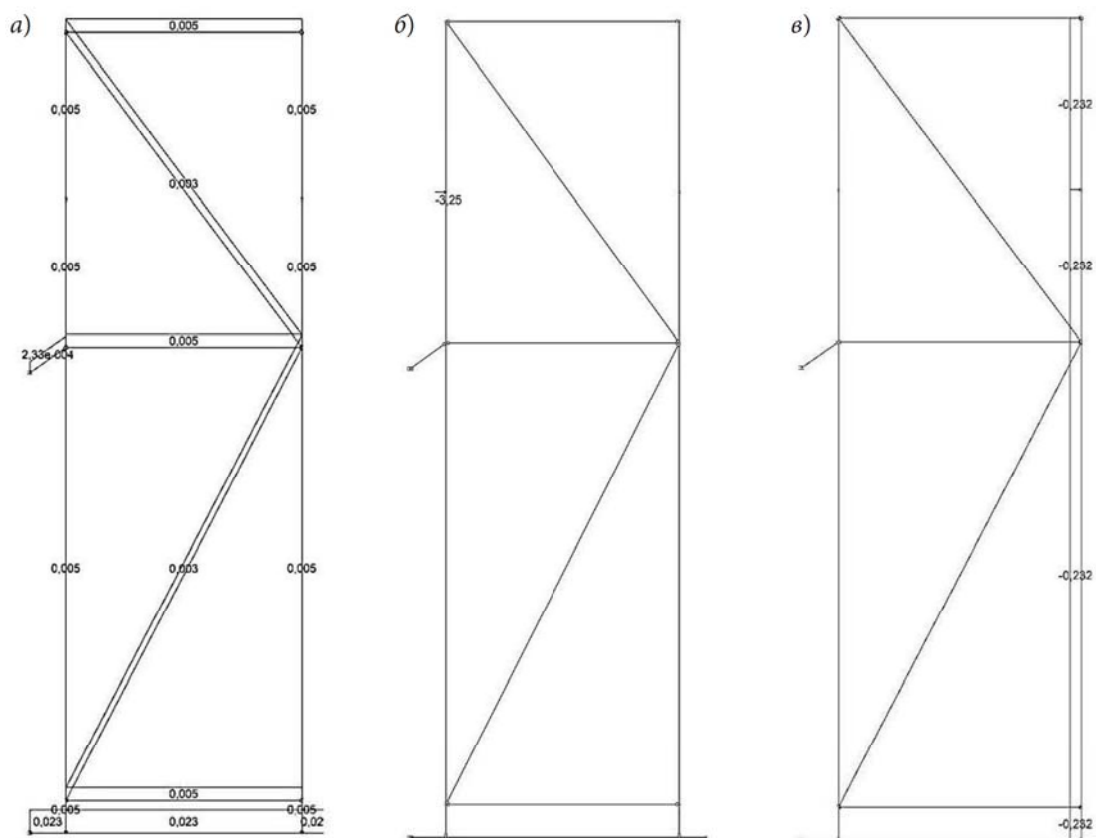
Этап I. Схема приложения: а — расчетных нагрузок от собственного веса конструкций (для загрузки L_1 , т/м); б — расчетной нагрузки от удара бабьи с учетом коэффициента динамичности (для загрузки L_2 , т); в — расчетной нагрузки от ветрового давления ($w_m + w_p$) для IV ветрового района (для загрузки L_3 , т/м)
